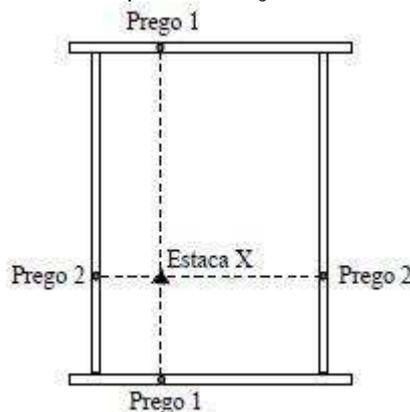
Planta com a localização da armação de madeira para a locação da obra
